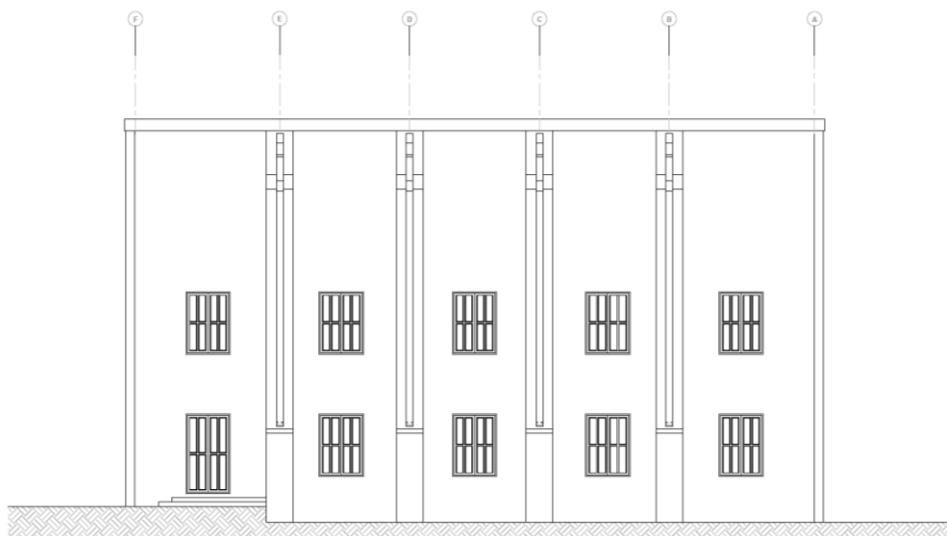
Alzado Norte del Auditorio. Levantamiento realizado en el año 2019. Fuente: Autora. Ver Planos en los Anexos.
